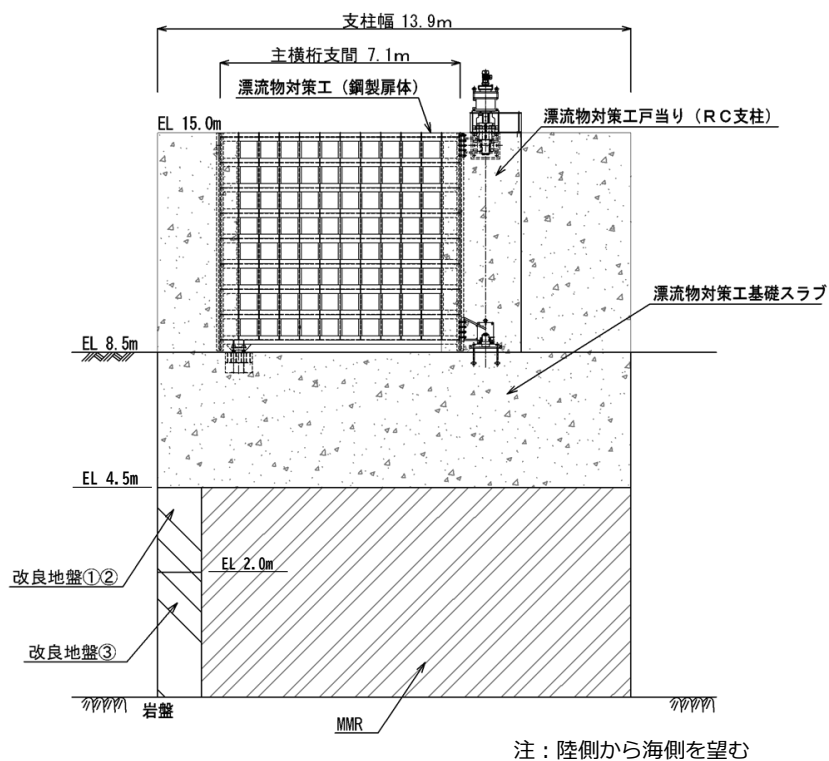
(1) 漂流物対策工の構造図 (基礎正面図, A-A 断面)
